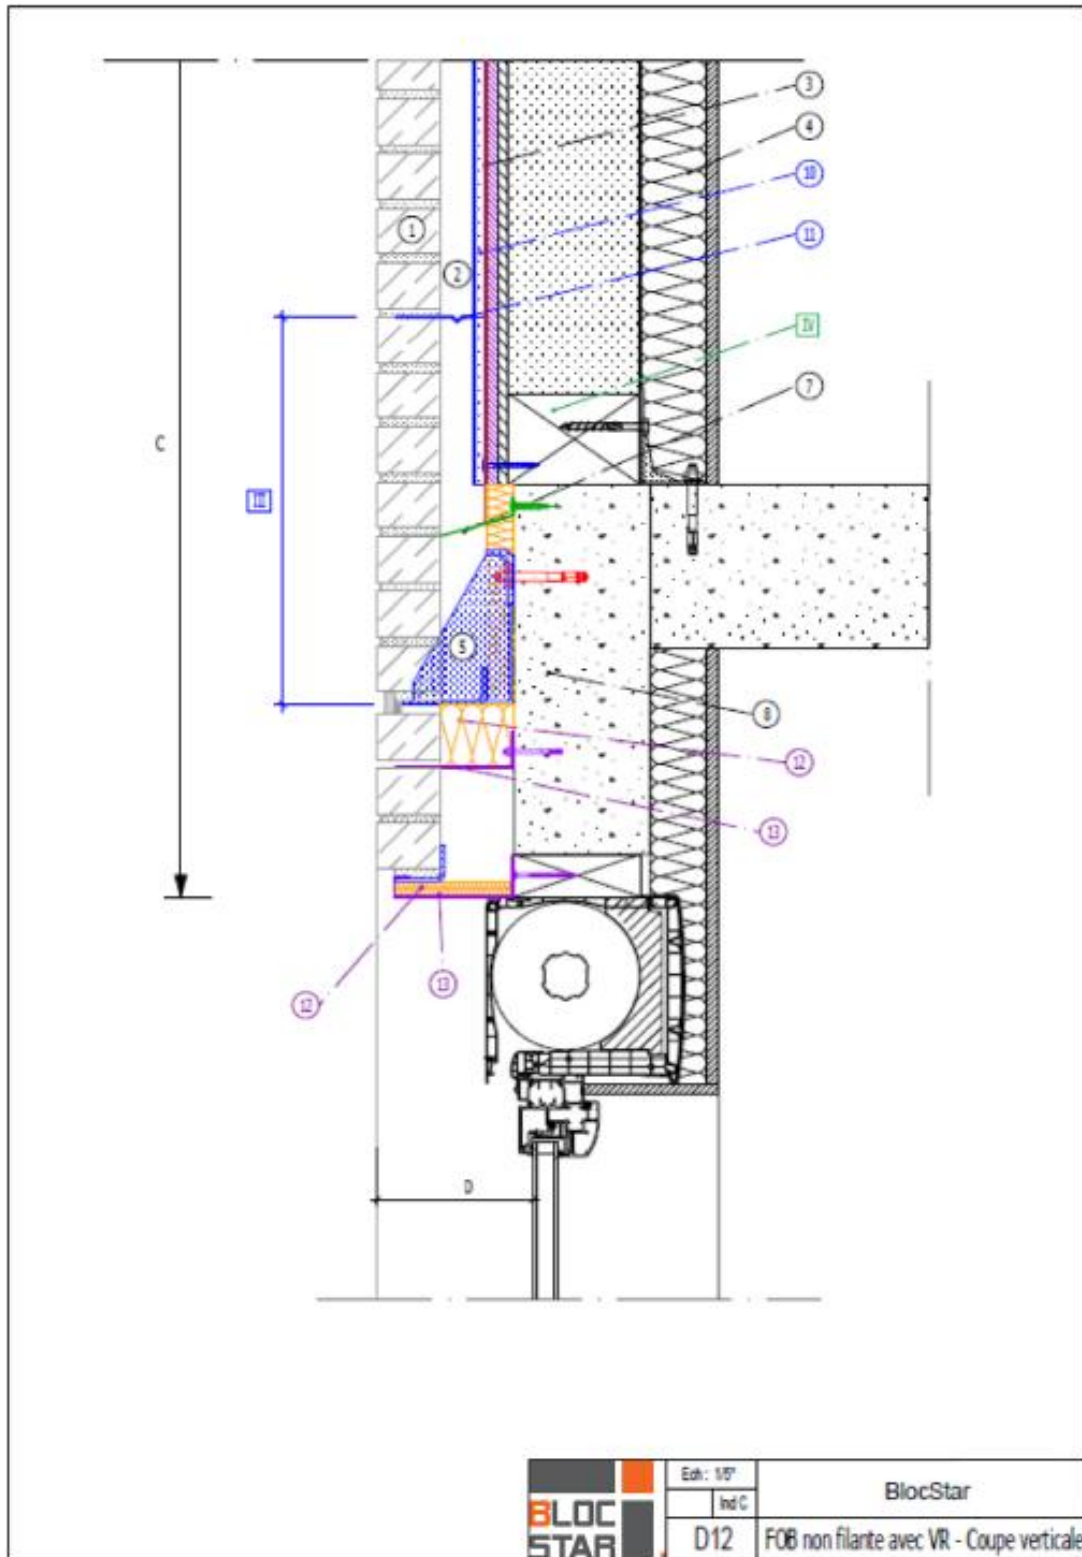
Traitement des embrasures – coupe verticale en linteau (FOB avec CVR)
